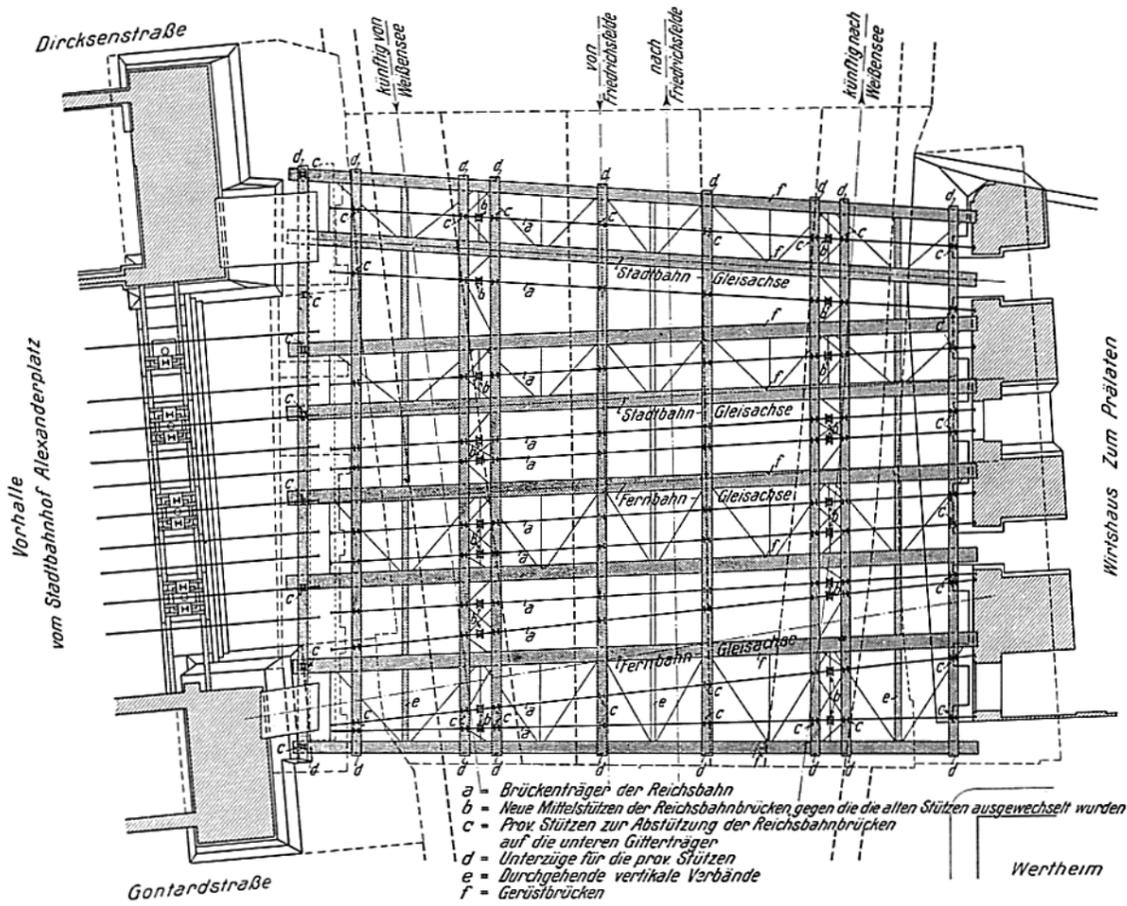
Stadtbahnüberführung in der Königstraße. Gerüstbrücke im Grundriß.
